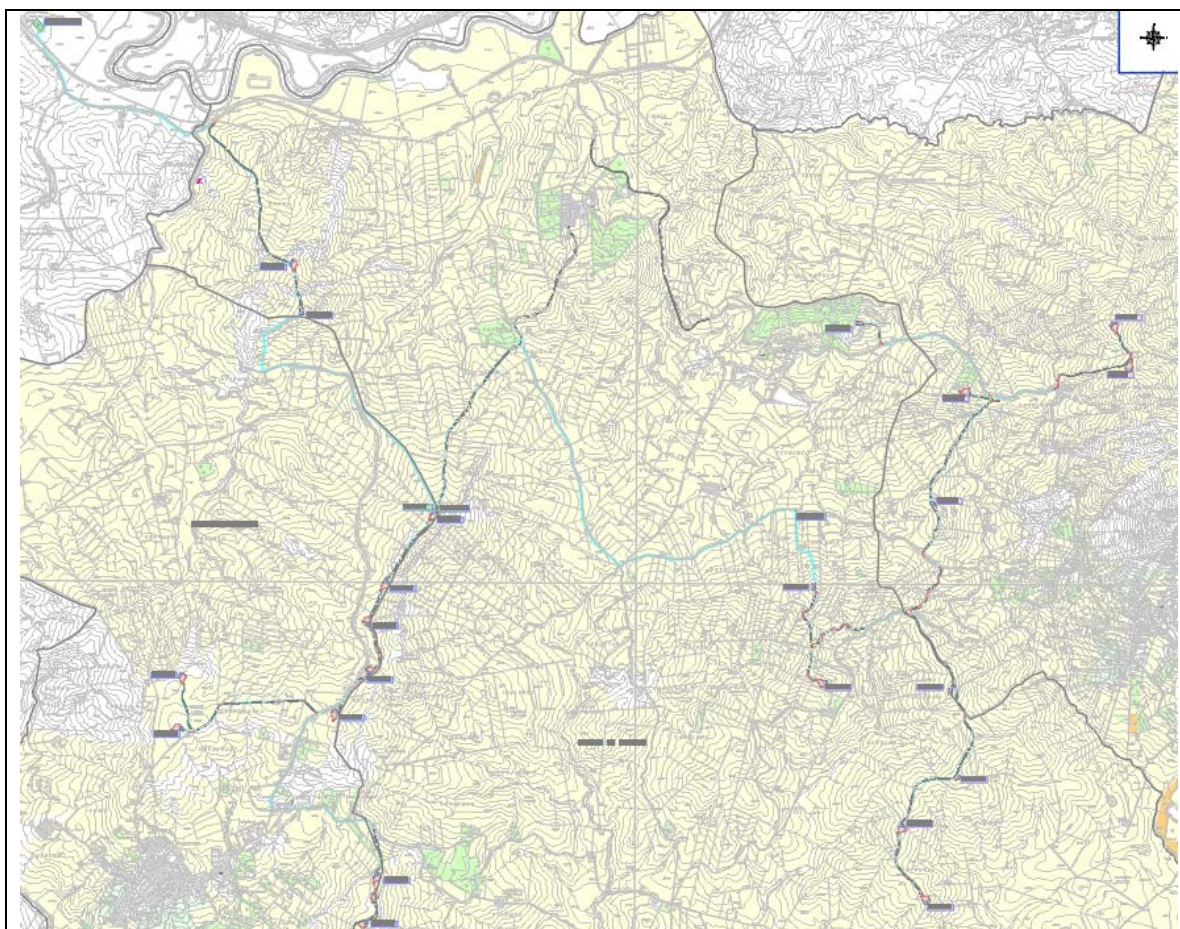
Stralcio della tavola REN-SA-T29, Layout 2
